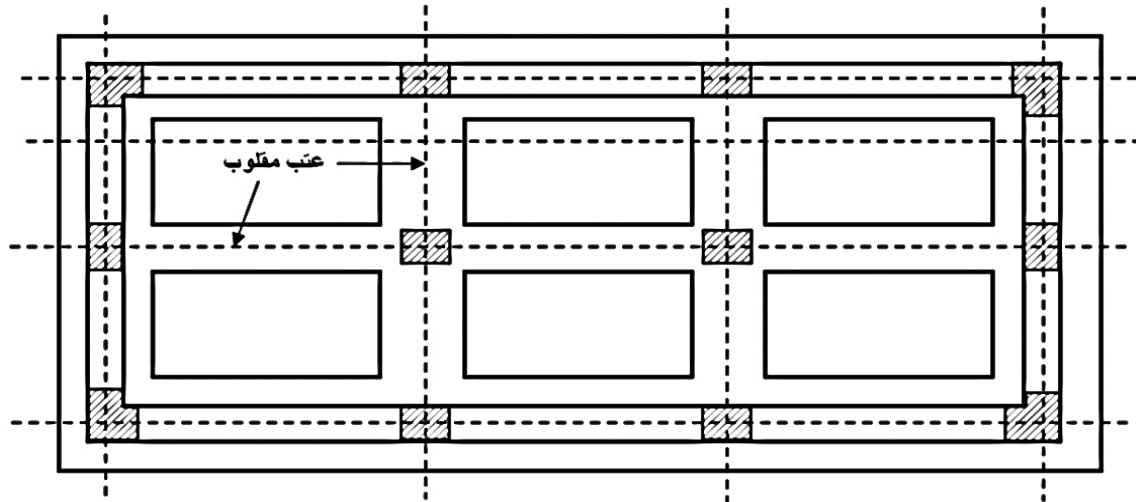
يوضح مقطع ومسقط لأساس حصيبي
